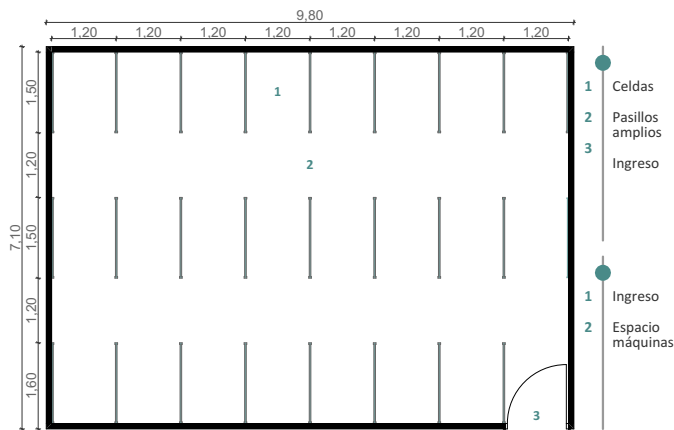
Planta de cuarto frío. Fuente: Autores.
